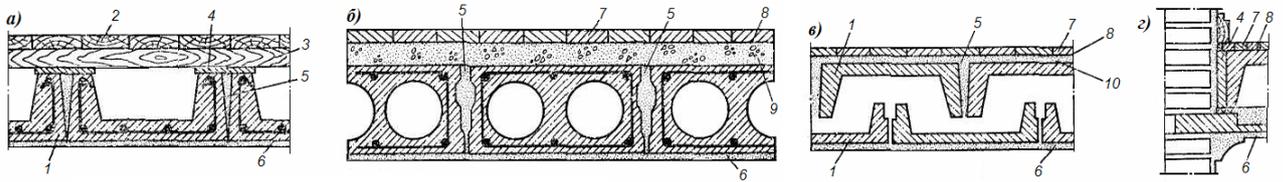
Междуэтажные перекрытия из настилов массой до 0,5 т: а – с применением лоткового настила; б – с применением двухпустотного настила; в – перекрытие раздельного типа; г – сопряжение со стеной;
